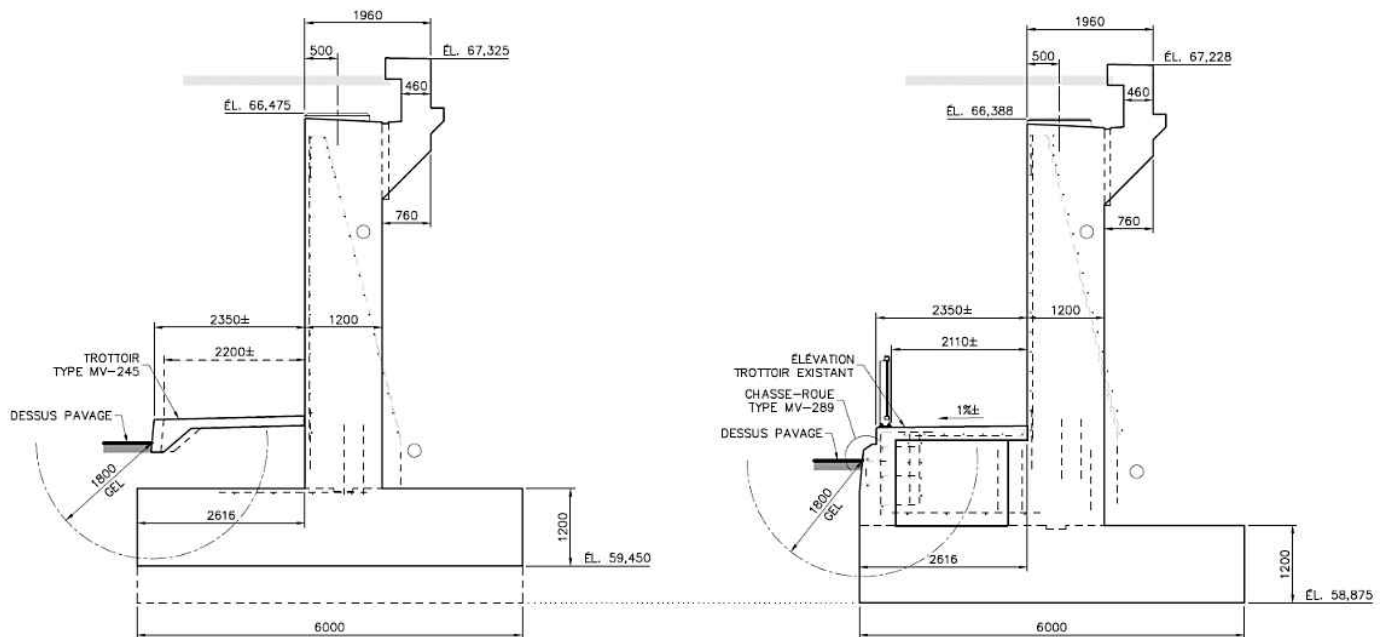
Pont d'étagement routier – Culée proposée axe 3 - Coupe type avec trottoir standard et trottoir structural
